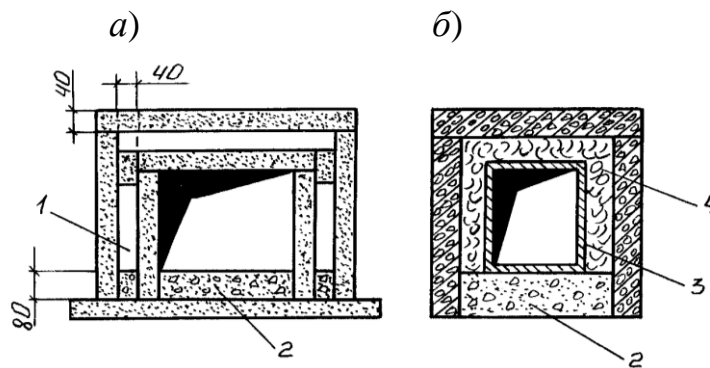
Устройство вентиляционных сборных коробов на чердаке: а – из шлакогипсовых плит; б – из бетонных плит; 1 – воздушная прослойка; 2 – шлаковая заливка; 3 – металлический воздуховод; 4 – утеплитель.
